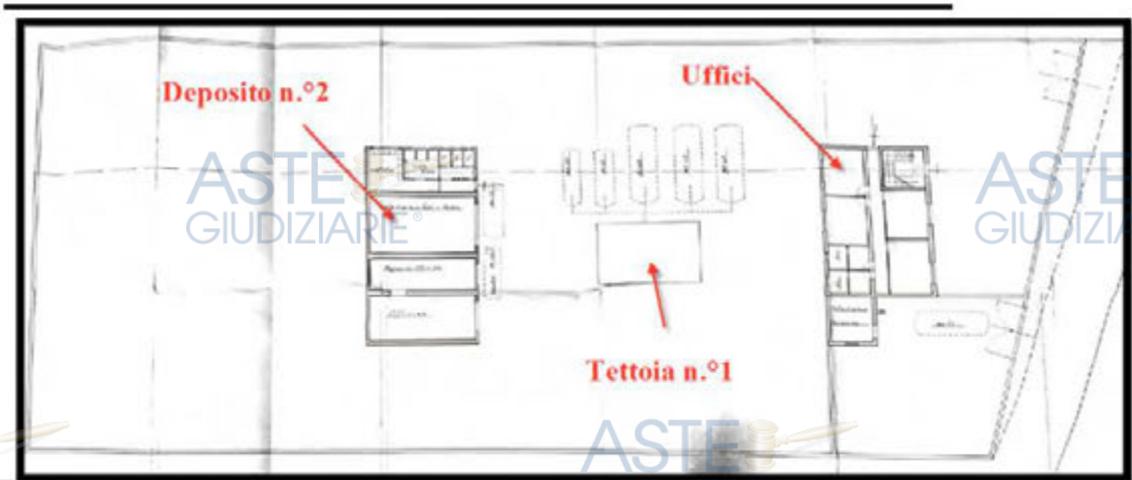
Planimetria generale allegata alla licenza edilizia n.°33650 del 26/7/1965
